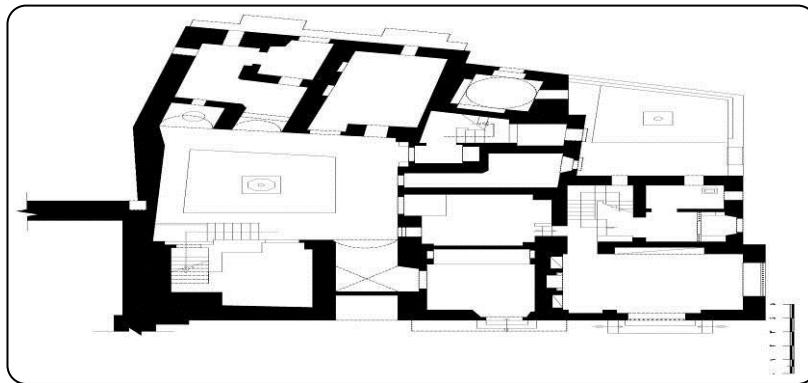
المسقط الأفقي للدور الأرضي للبيت العثماني موضع
